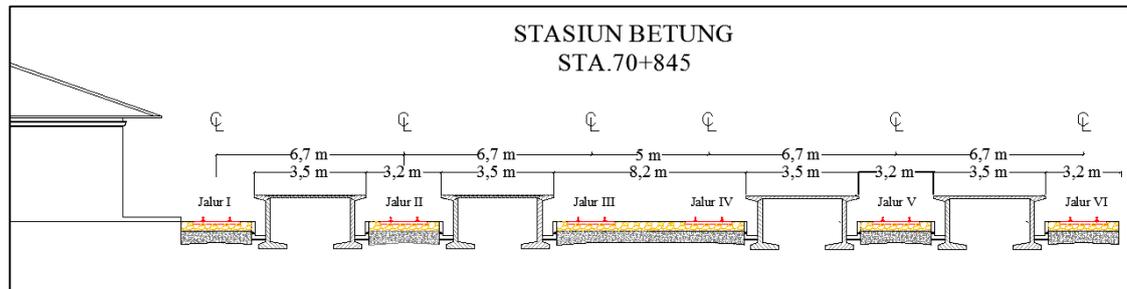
12 Layout denah tata letak jalur di Stasiun Betung
